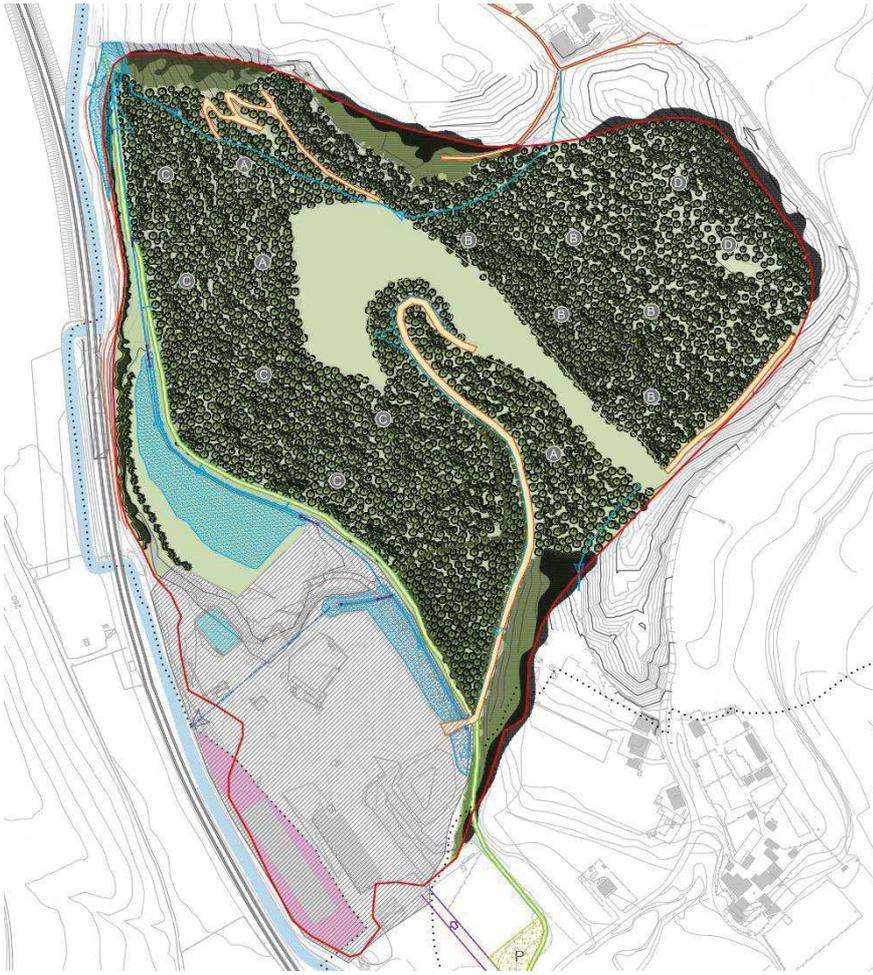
Planimetria generale degli interventi di rinaturalizzazione
